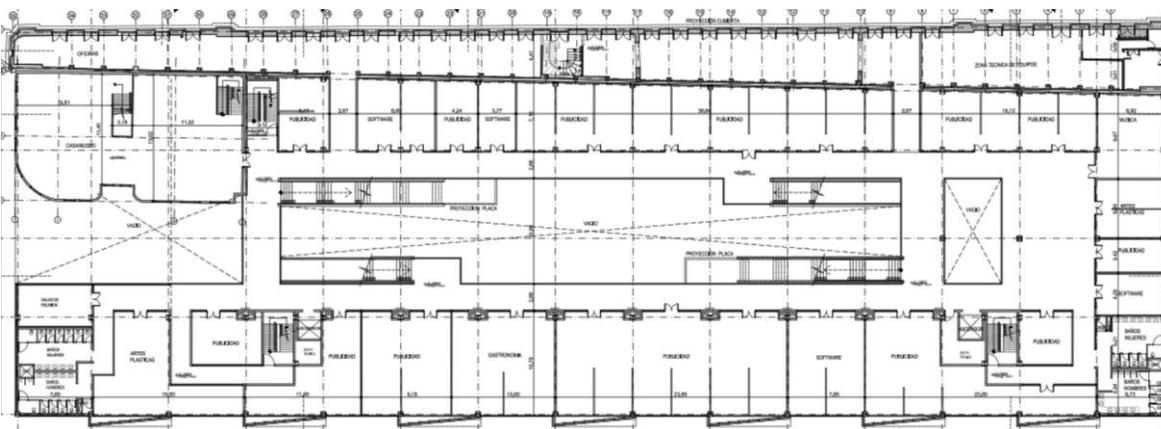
Planta tercer piso – EDIFICIO CREATIVO
